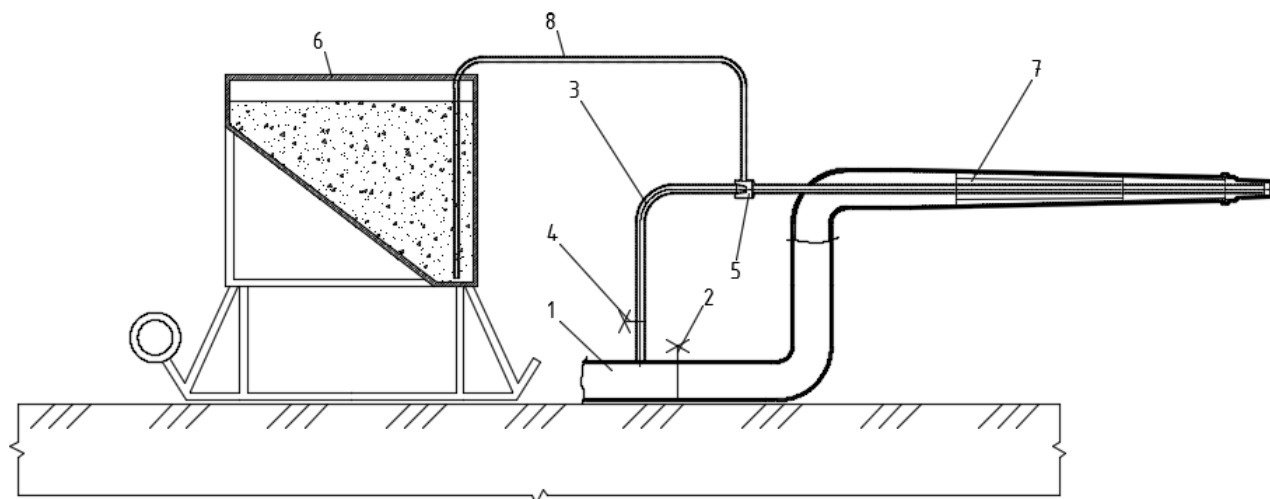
Схема гидромонитора с эжектирующим приспособлением
